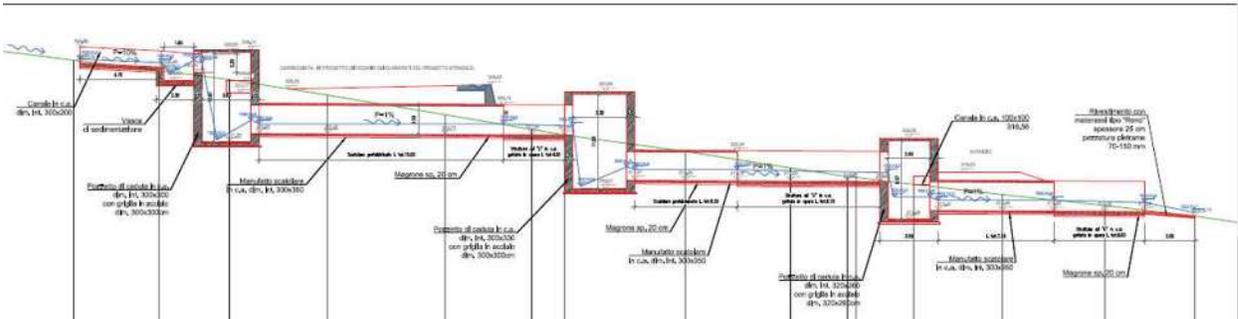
Incisione B (OP3-056) – Sezione longitudinale
